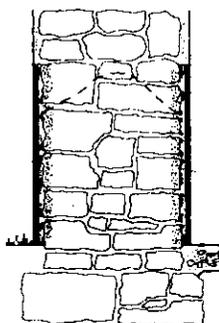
Использование ремонтных штукатурок с наружной и внутренней сторон стены здания
